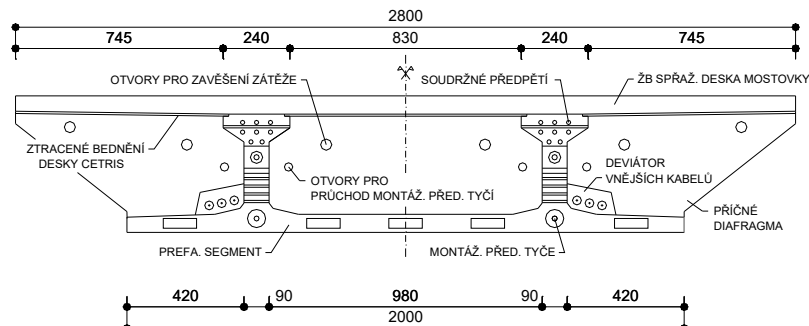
Vedení kabelů II. Fáze, kabelů spojitosti
